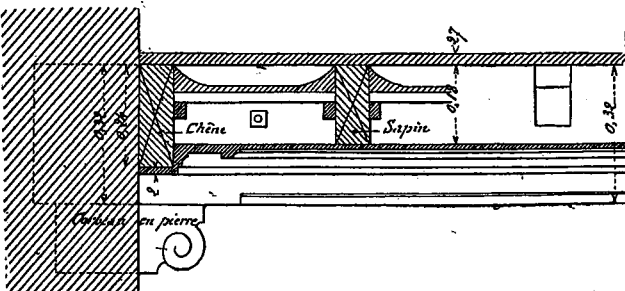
Coupe suivant AB du plan (fig. 317).
